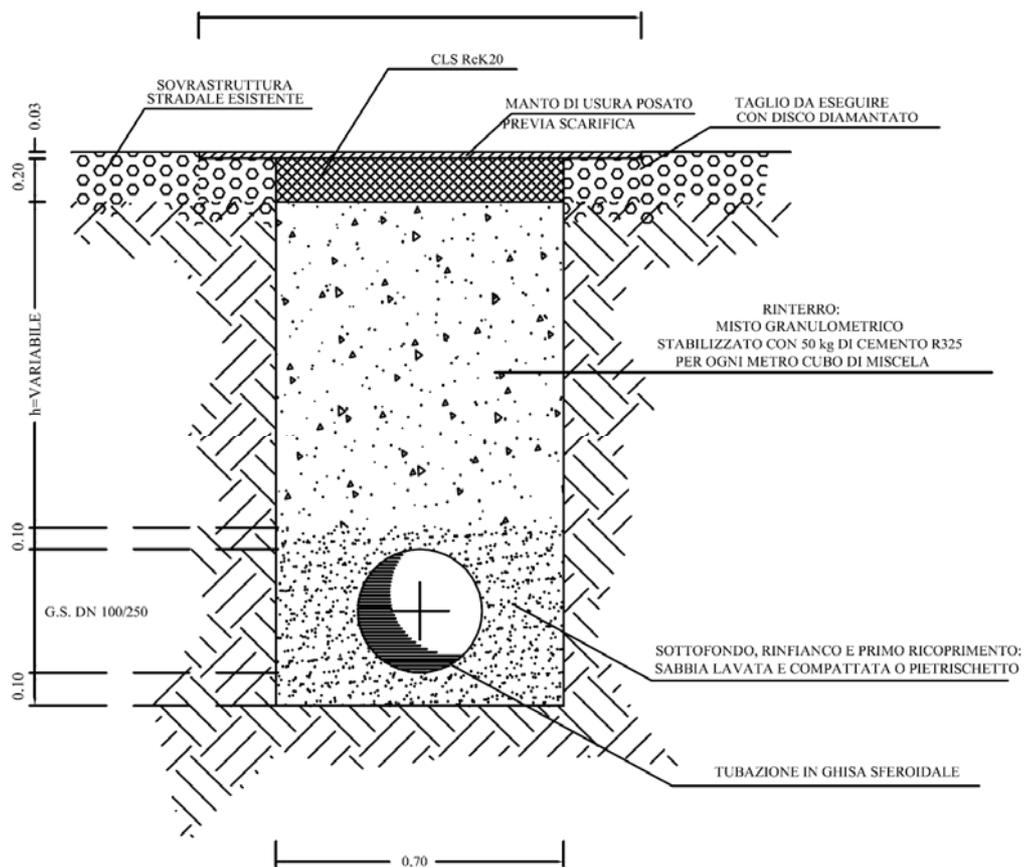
Sezione tipo di posa delle condotte su strada asfaltata
